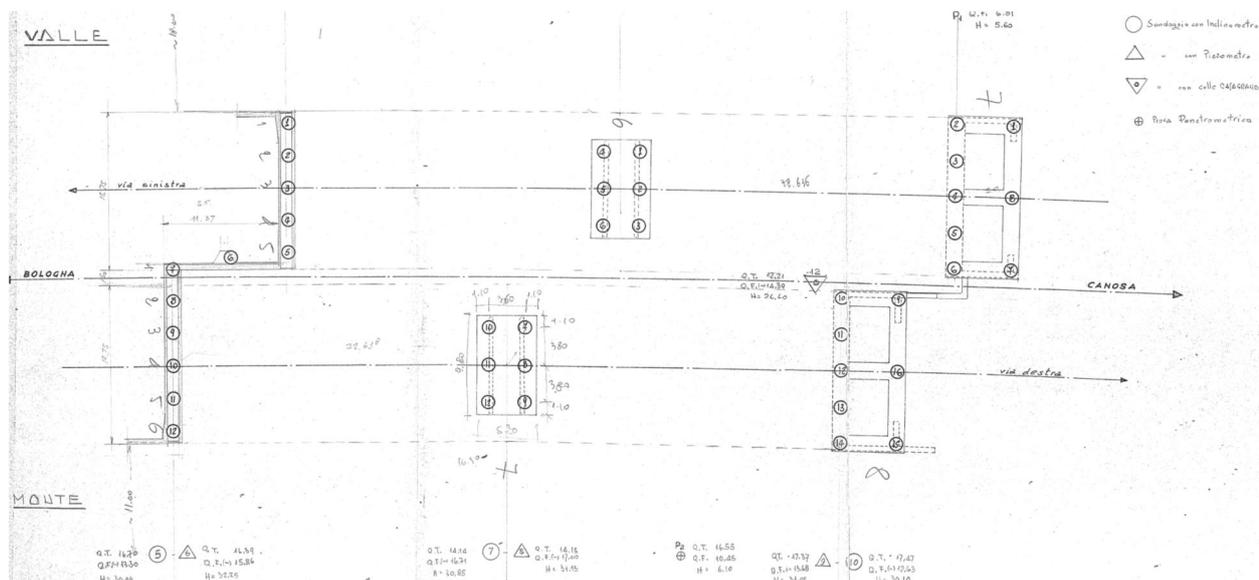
Viadotto Cacchione – Planimetria (dalla Contabilità lavori) (Doc.Ref.[7])
